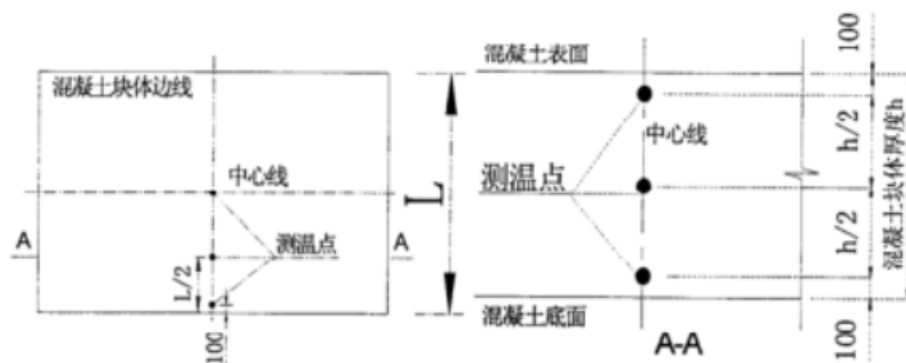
测温点标准平面和剖面布置示意图 (单位: mm)
